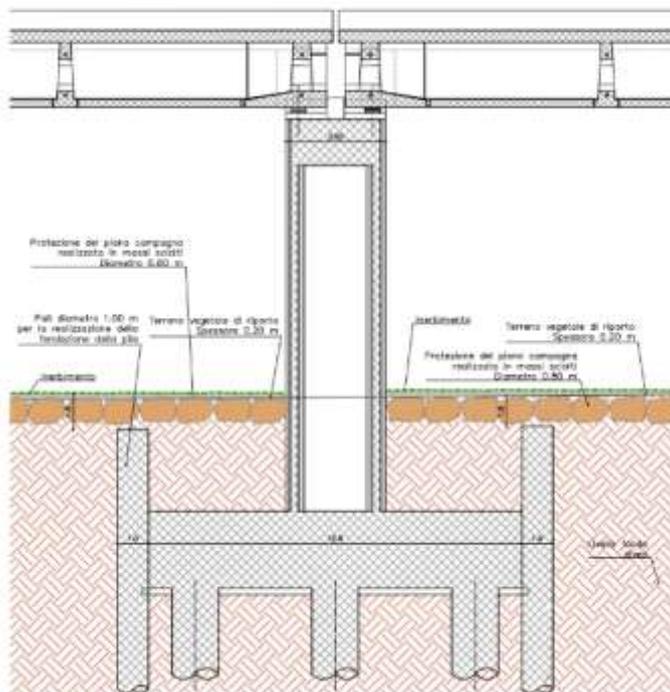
Sezione di dettaglio della sistemazione idraulica in corrispondenza di una pila del viadotto fuori alveo (da PD).
